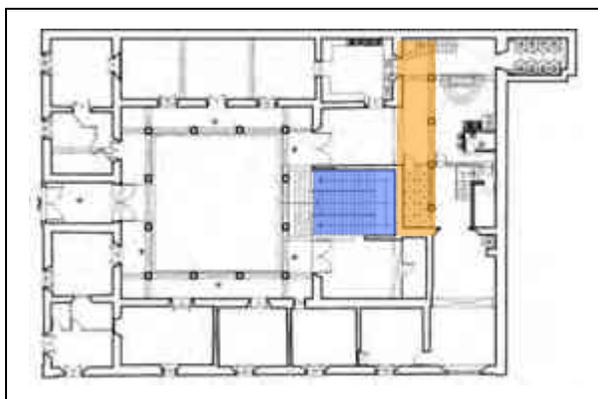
Planta baja, como Casa del Estudiante Nicolaíta, zona naranja área de cambio de vigería el año 2002, por el Ing. Tavera Montiel. Zona azul cubo de escalera, vigería cambiada por el Ing. Bolaños Guzmán en 1992.
